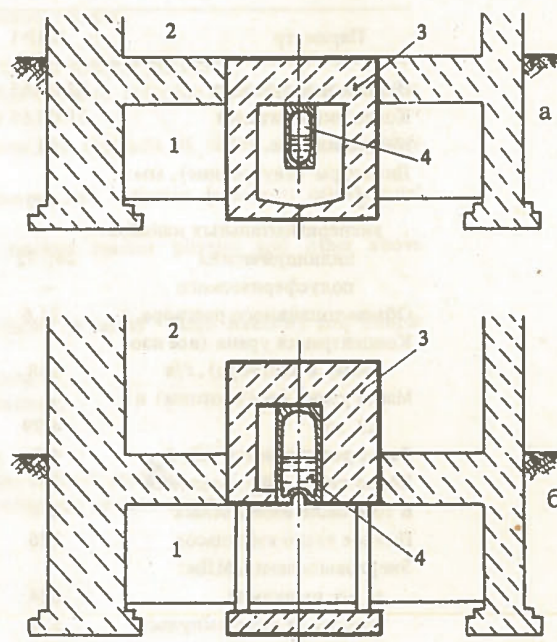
Компонентные схемы установок с реакторами типа ВИР (а — установка ВИР-1, б — установка ВИР-2): 1 — нижний реакторный зал; 2 — верхний реакторный зал; 3 — блок биологической защиты с бункером реактора; 4 — корпус АЗ реактора
